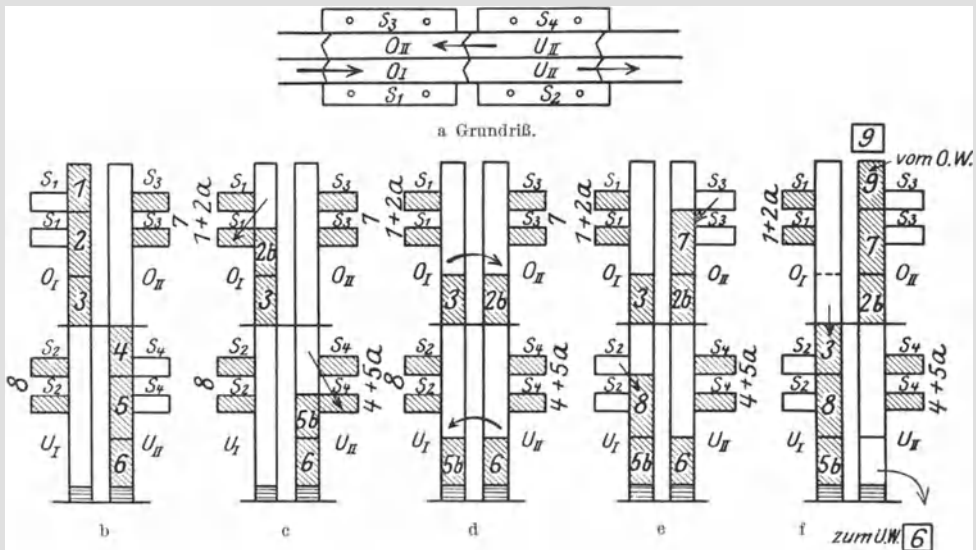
a bis f. Doppelte, zweistufige Umlauftrappe, D.R.P. der Siemens Bauunion, Berlin.
